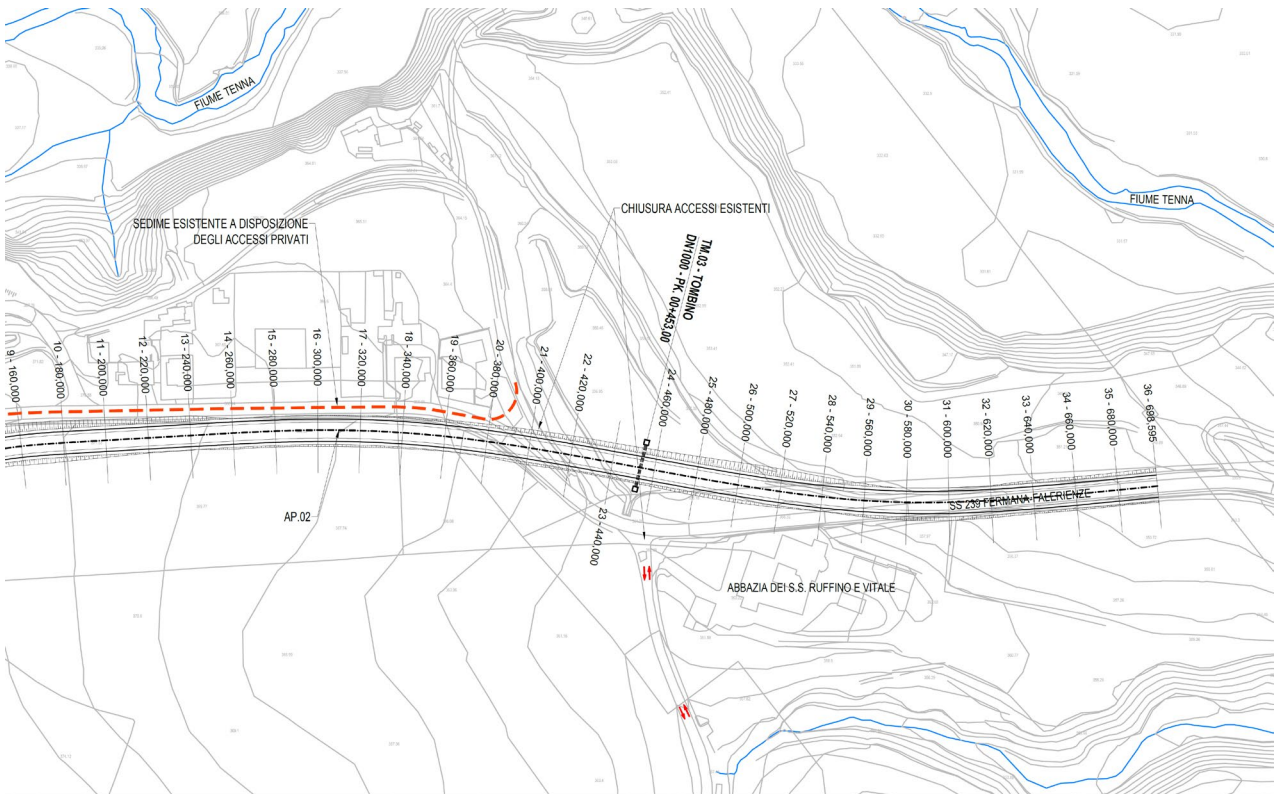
Planimetria del tratto prospiciente l'abbazia di San Ruffino e Vitale
